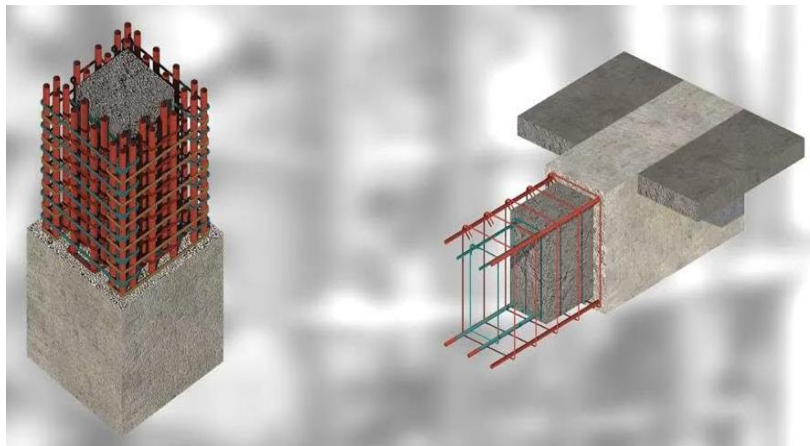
Técnicas de rehabilitación | Encamisado de vigas y columnas
